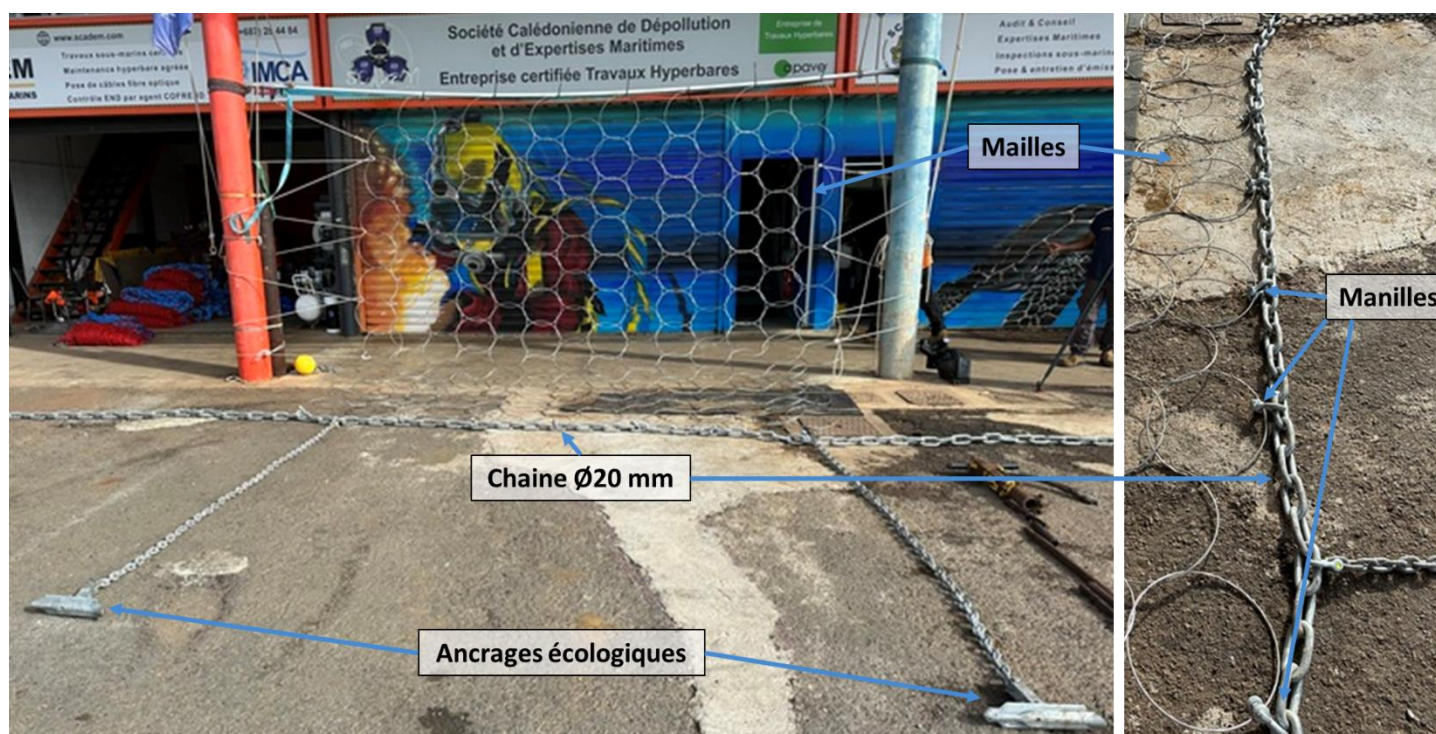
Photos de détails de la barrière en cours d'assemblage
